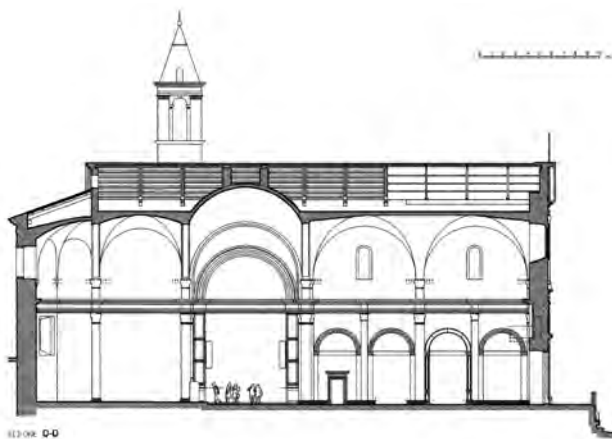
Chiesa di San Pietro in Montorio, sezione longitudinale (rilievo di F. Cantatore).
